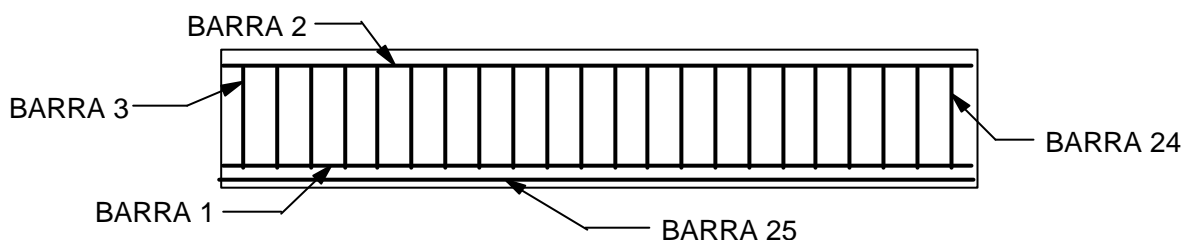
Discretização da armadura da viga reforçada com camada de argamassa aditivada
